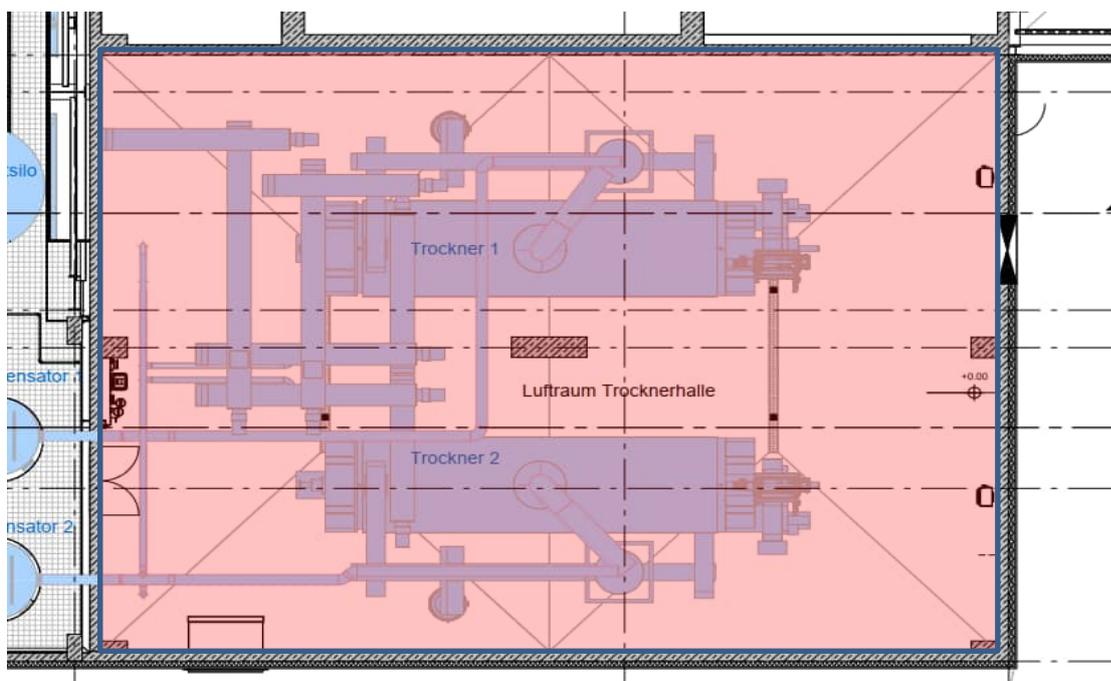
AwSV-Fläche Trocknerhalle (rot)
